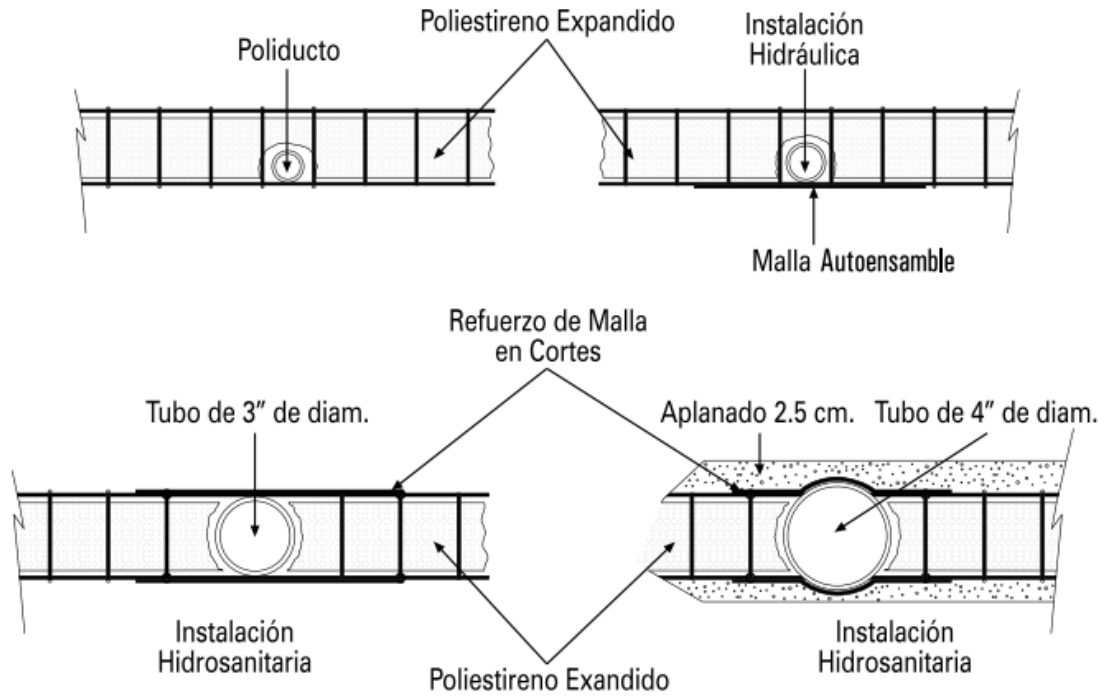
Instalaciones en el sistema Covintec (Planta).
